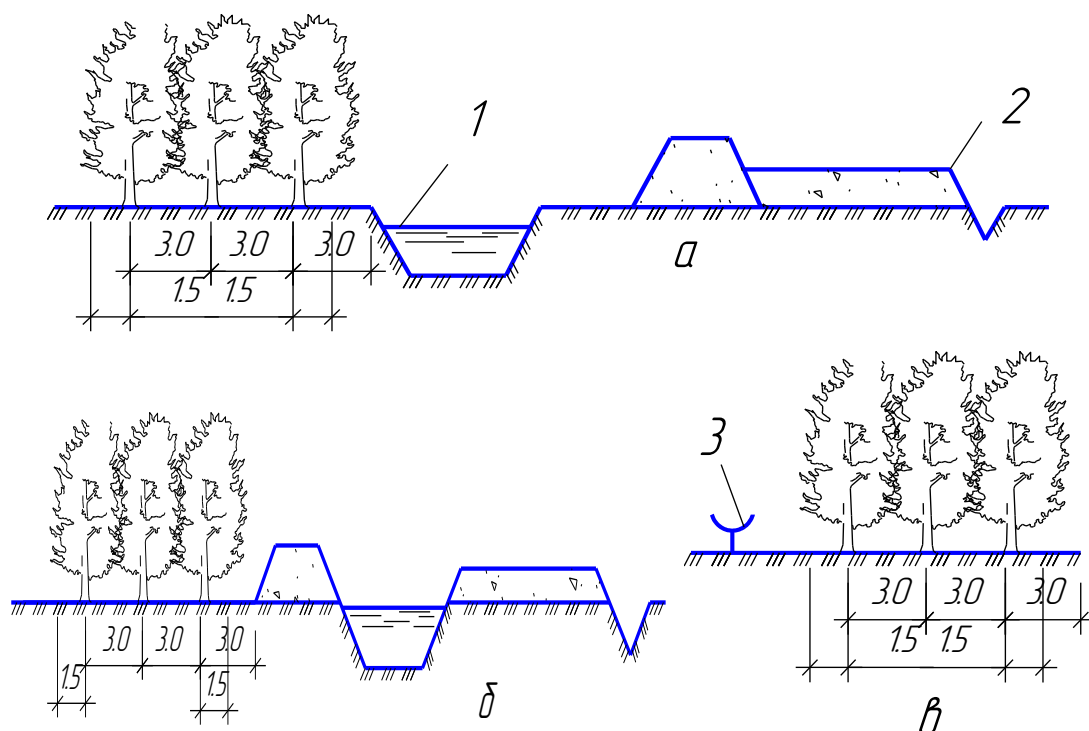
Схемы размещения защитных лесных полос вдоль хозяйственных оросительных и коллекторно-сбросных каналов, лотковой сети и подземных трубопроводов
